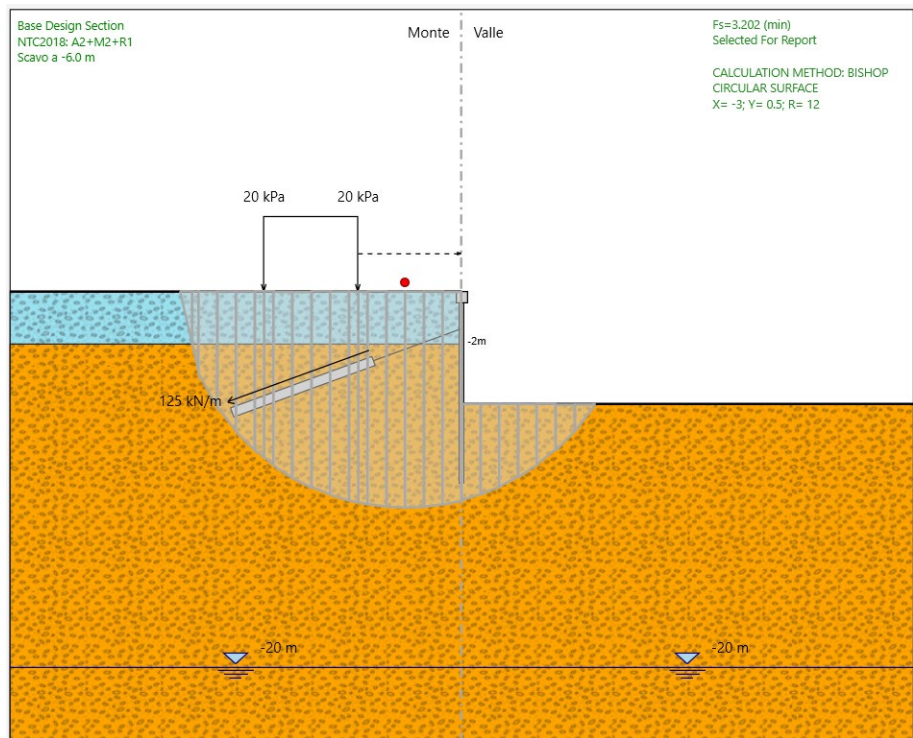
Sezione Tipo B - Condizioni statiche (FS=3.2)
